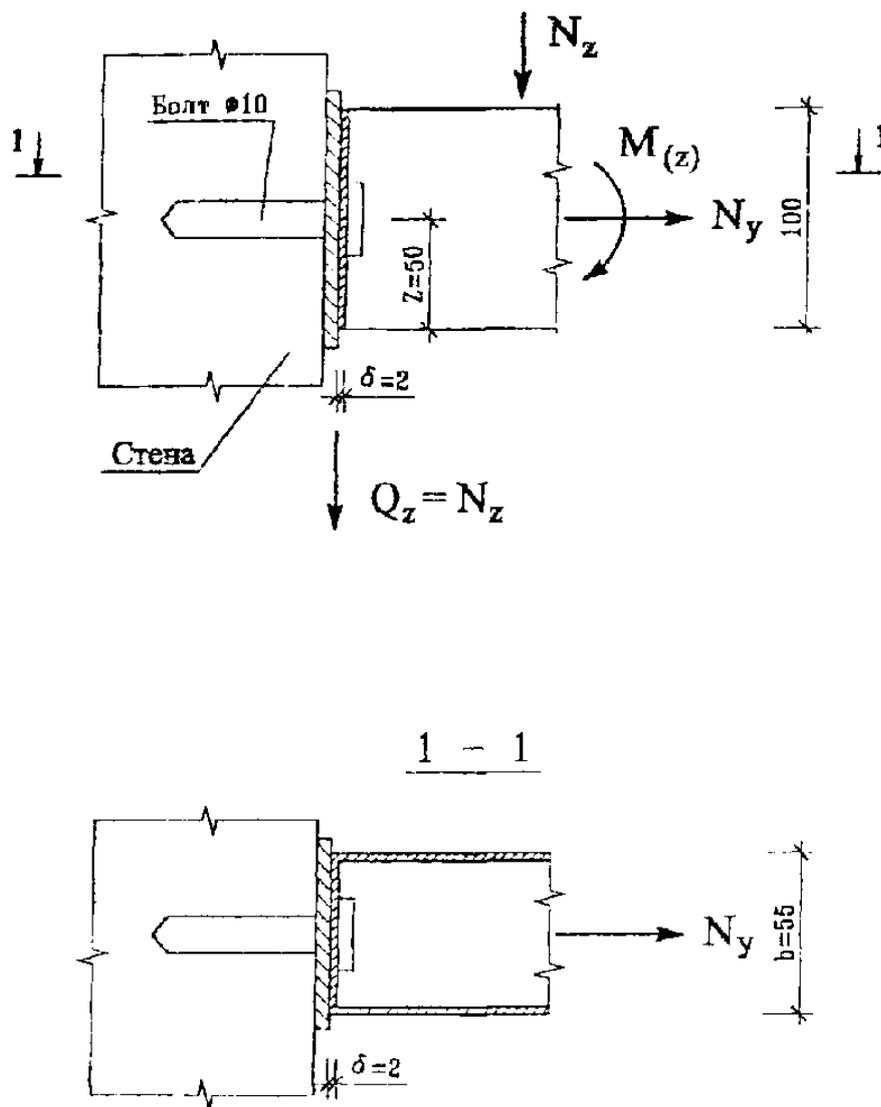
Расчетная схема крепления несущего кронштейна.
